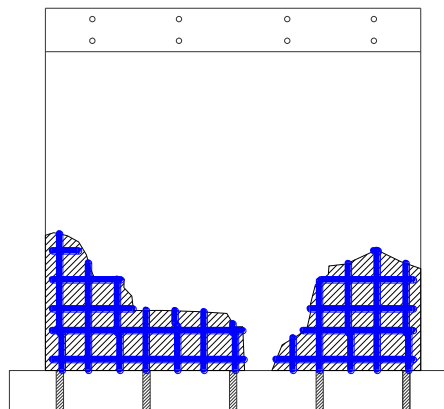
Agrietamiento de muro de albañilería confinada con ladrillos pandereta industrial en la distorsión 1/2150.
